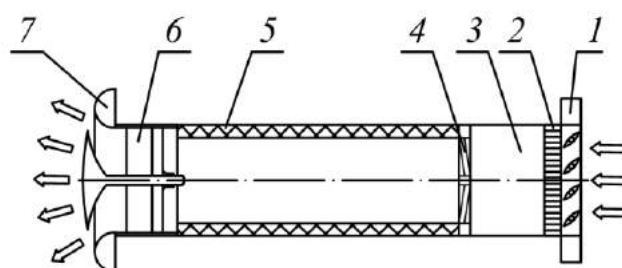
Стеновой приточный клапан: 1 – решетка; 2 – сетка; 3 – пластиковый цилиндр; 4 – ограничитель притока воздуха; 5 – теплоизоляция; 6 – фильтр G3; 7 – приточное устройство
